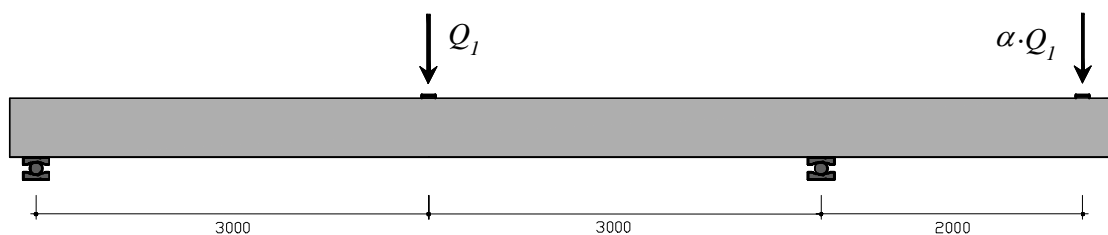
Exemple d'essai d'une bande de dalle sans étriers, 2004 [Rodrigues04]
